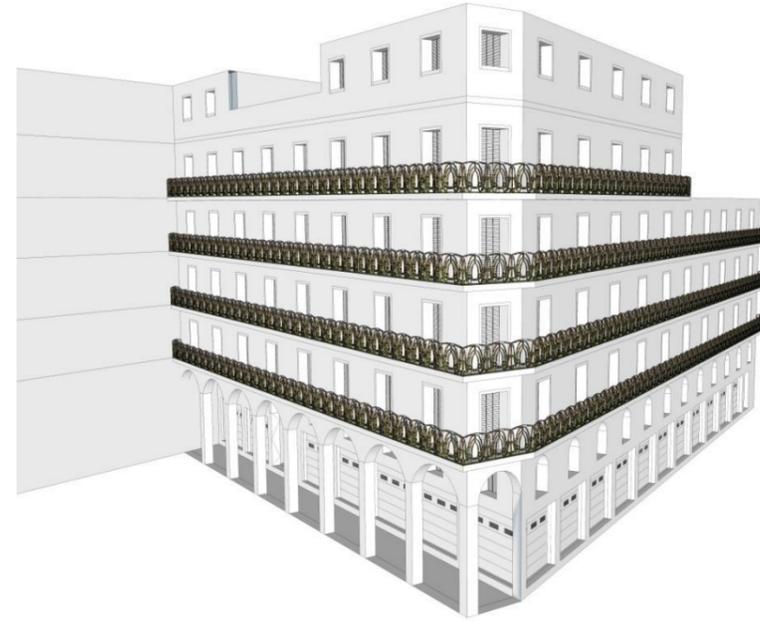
disposition des ouvertures au niveau des deux façades principales de l'immeuble.
